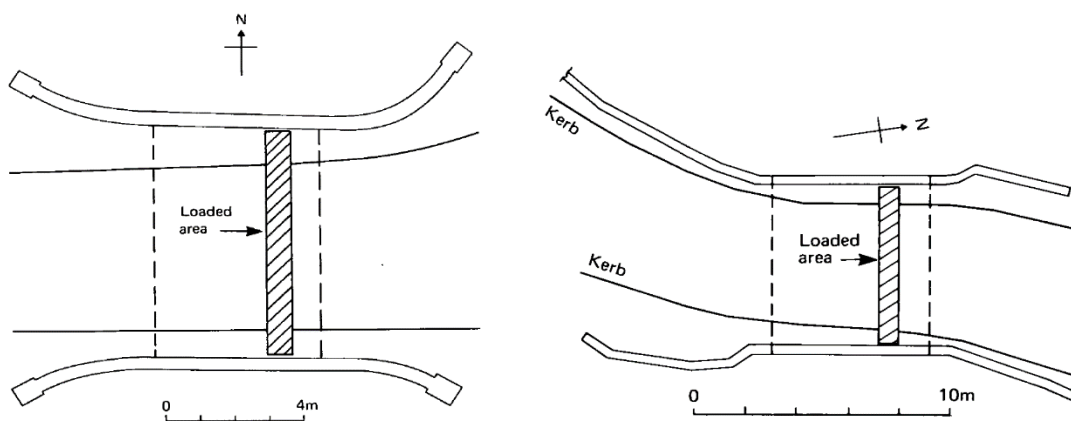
Torksey Bridge* (a sinistra) e *Shinafoot Bridge* (a destra): planimetria con indicazione dell'area caricata. [48]
